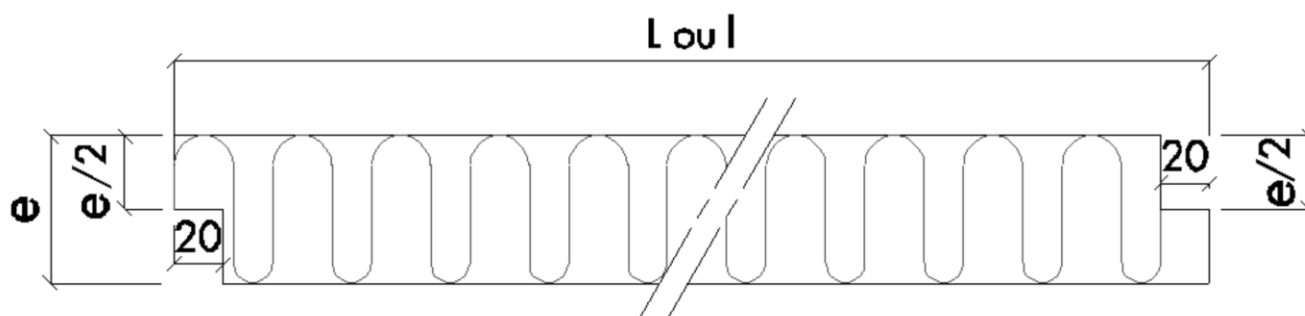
Coupe de principe sur le panneau Fesco C-DO d'épaisseur (e) égale à 40, 50 ou 60 mm
